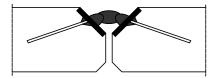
Пример армирования стены над соединением двух плит перекрытия
